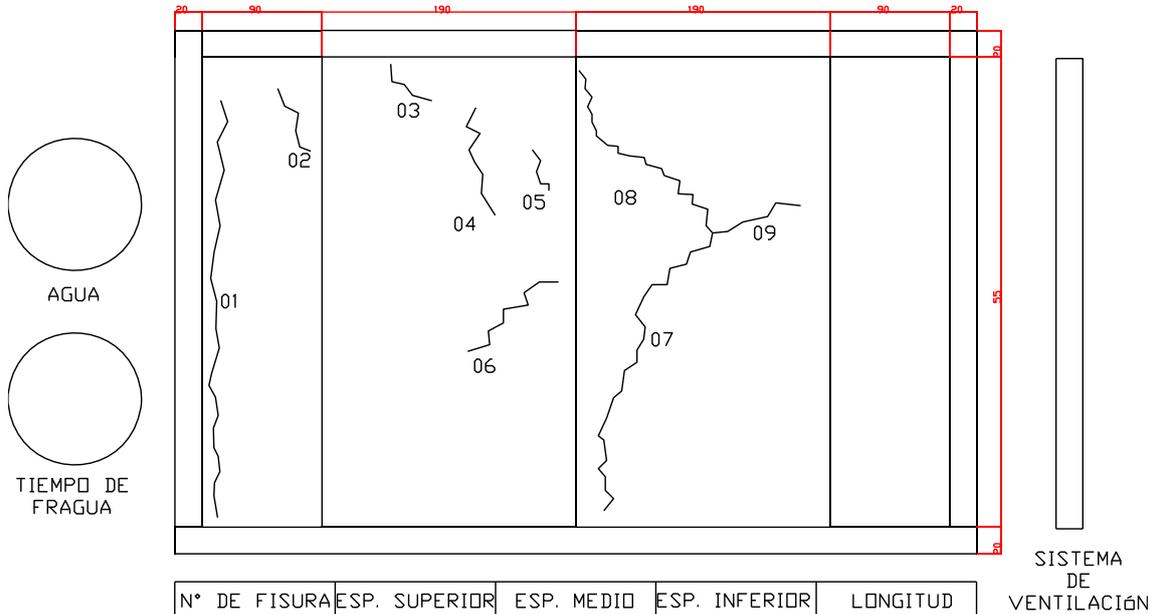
Identificación de las primeras fisuras después de las 6 horas de vaciado.
